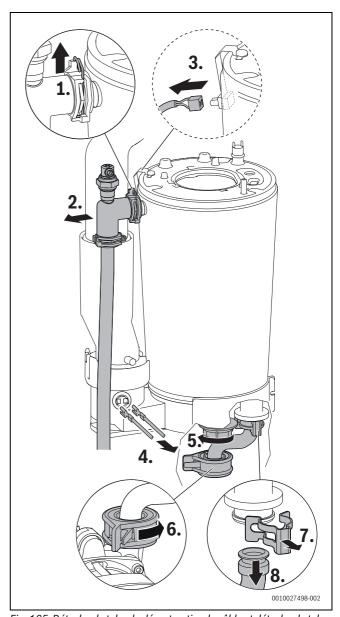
Détacher le tube de départ, retirer le câble et détacher le tube retour
